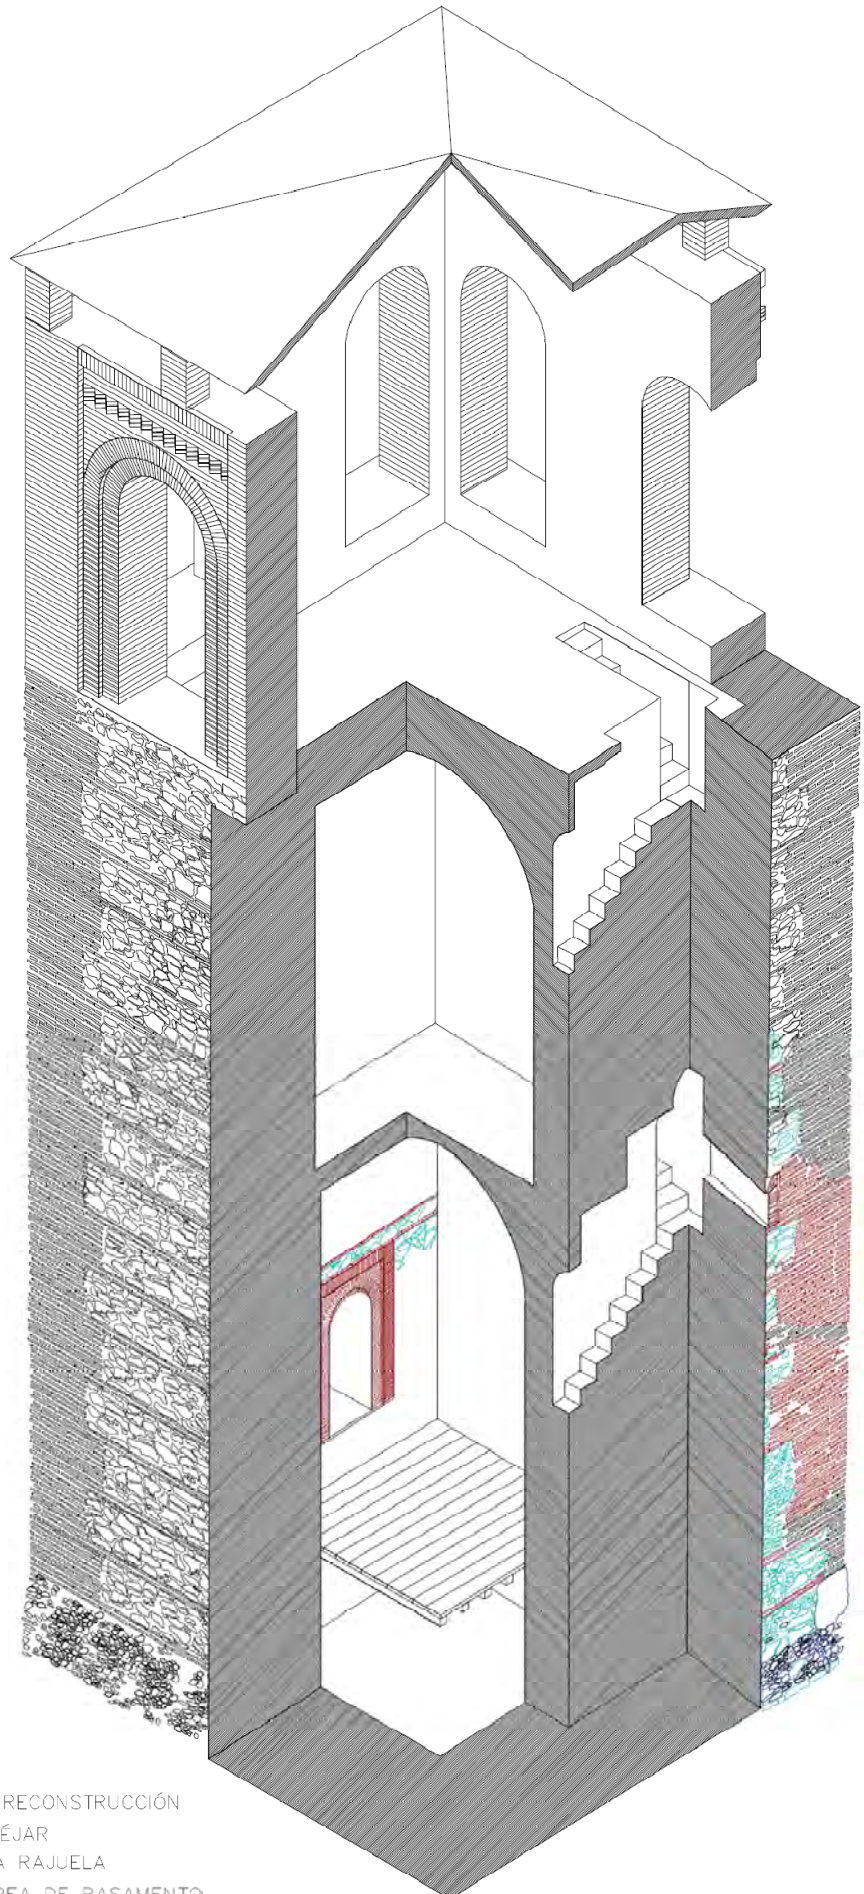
axonometría seccionada por las cámaras y por las escaleras de comunicación entre ellas.
